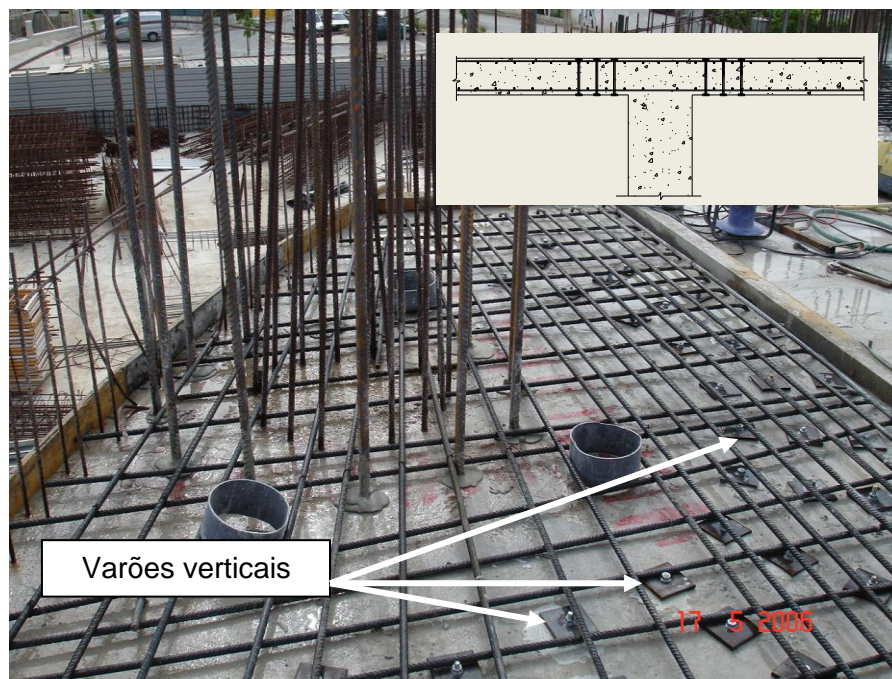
Introdução de varões verticais de reforço – vista da face superior [184].
